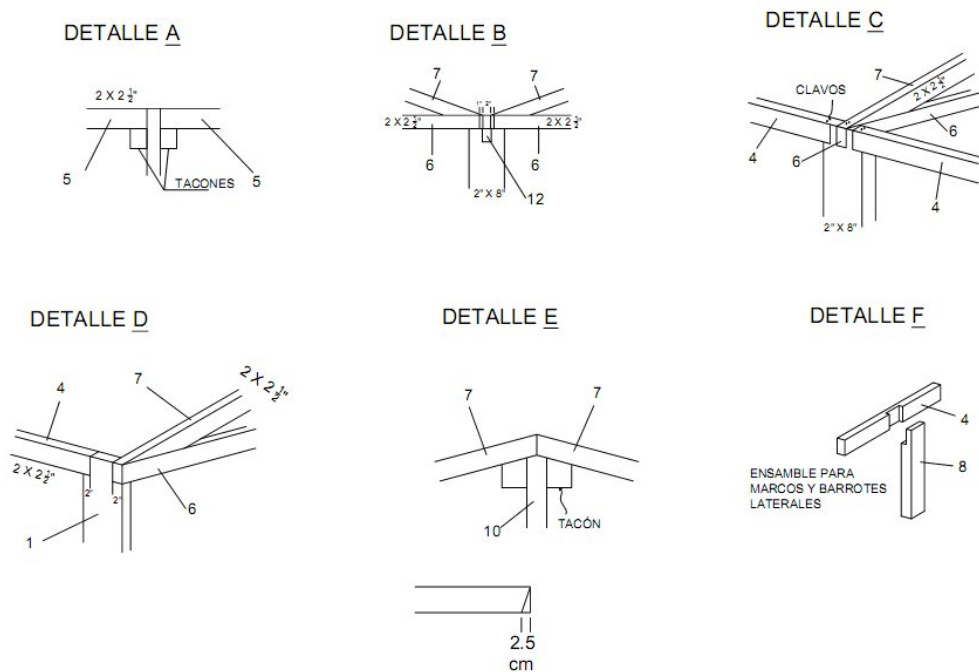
Detalles de construcción de un invernadero con estructura de madera.
